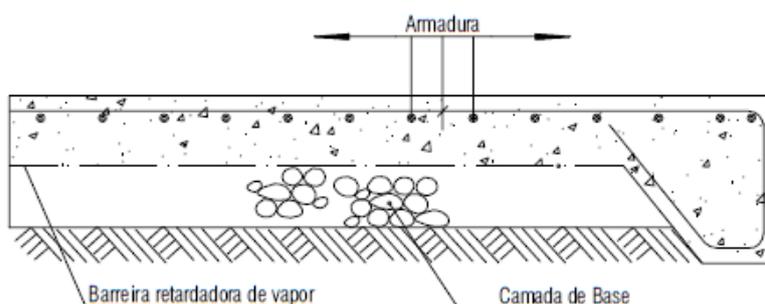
Encurvadura dos bordos da laje de um pavimento [11]
